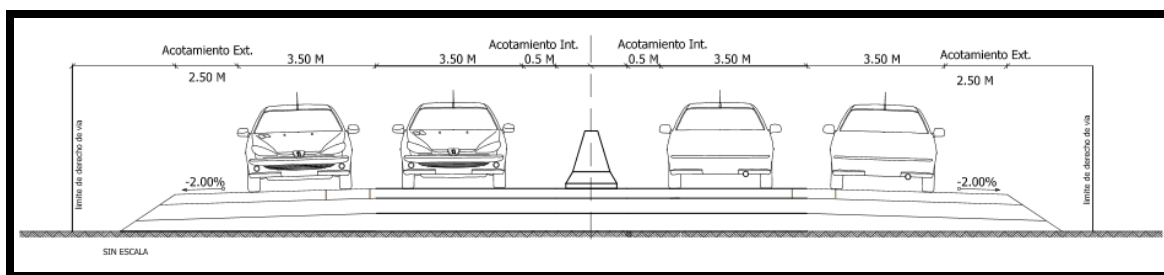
Sección tipo autopista Perote-Banderilla. Fuente SCT.
